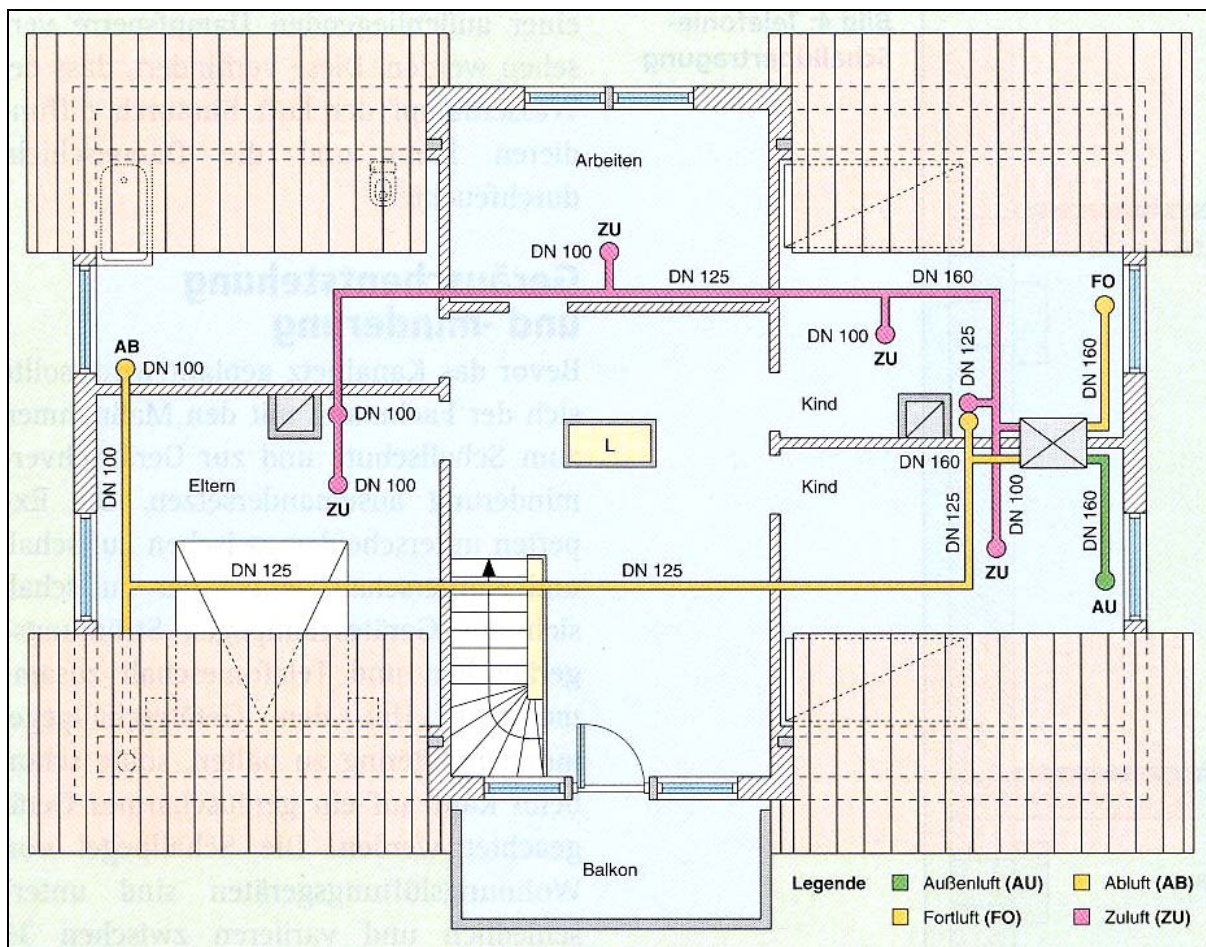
Entwurf einer Leitungsführung für eine Geräte-Installation auf dem Dachboden
